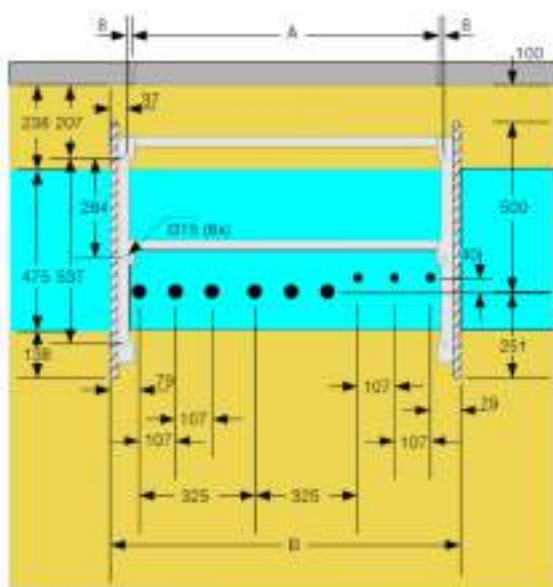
Схема установки КРУЭ на полу, около стены, с изображением кабельных вводов на примере SafeRing из 3-х присоединений с болтовыми кабельными вводами серии 400 для присоединений 1, 2 и штекерными вводами серии 200 для 3-го модуля.
